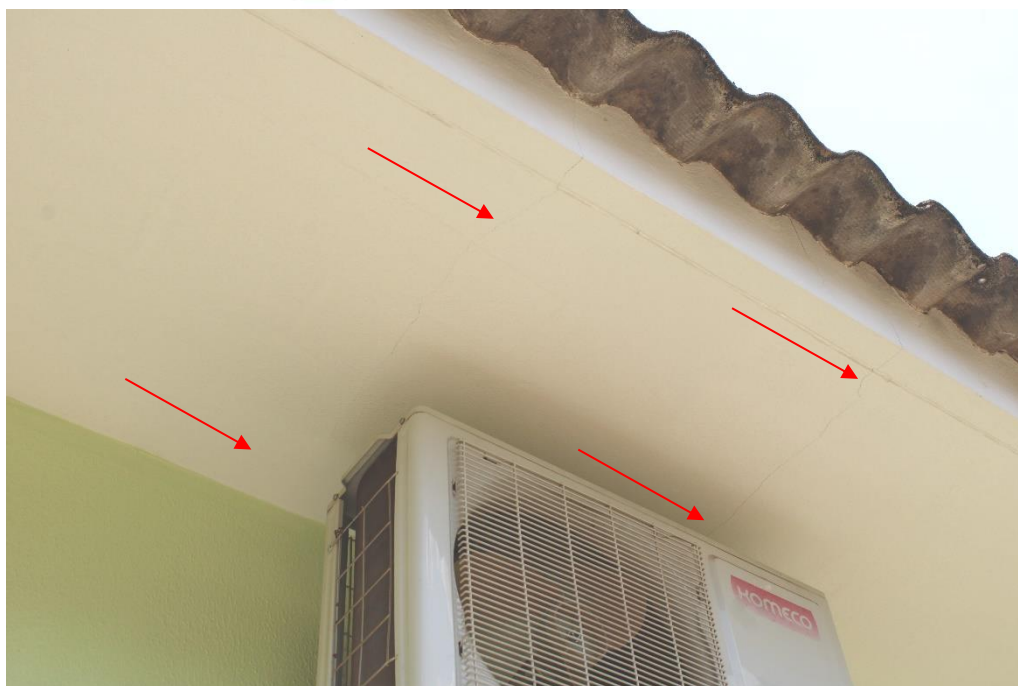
Em detalhe a Foto 65, destacando fissuras na laje de teto (região do beiral).
